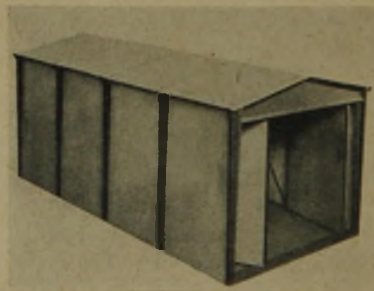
Leichtbaukraftwagenhalle, System Marlin, mit Stahlkonstruktion aus gepreßten Stahlblechen. Bekleidung: Kunststeinplatten, Bimsbeton oder dergleichen
